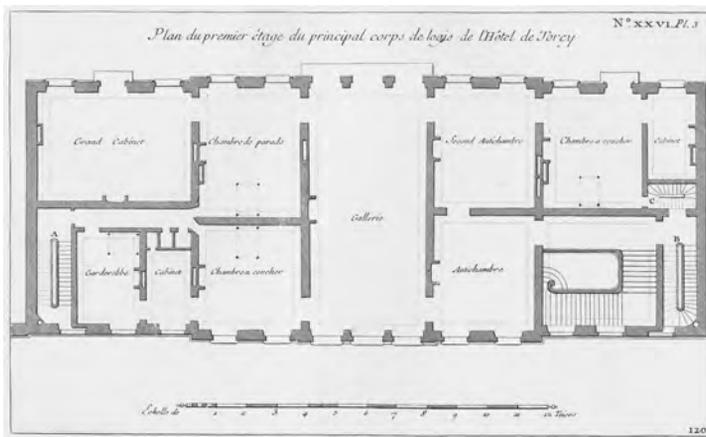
Paris, Hôtel de Torcy, Grundriss, Obergeschoss
